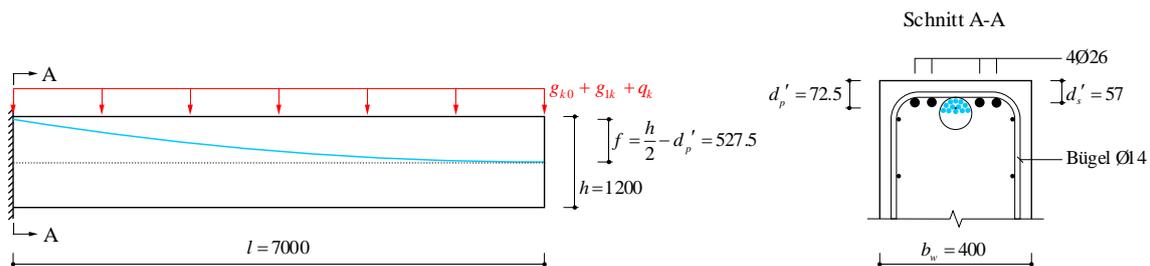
Trägerabmessungen, Spanngliedführung, Belastungsanordnung und Bewehrung. Abmessungen in mm.
